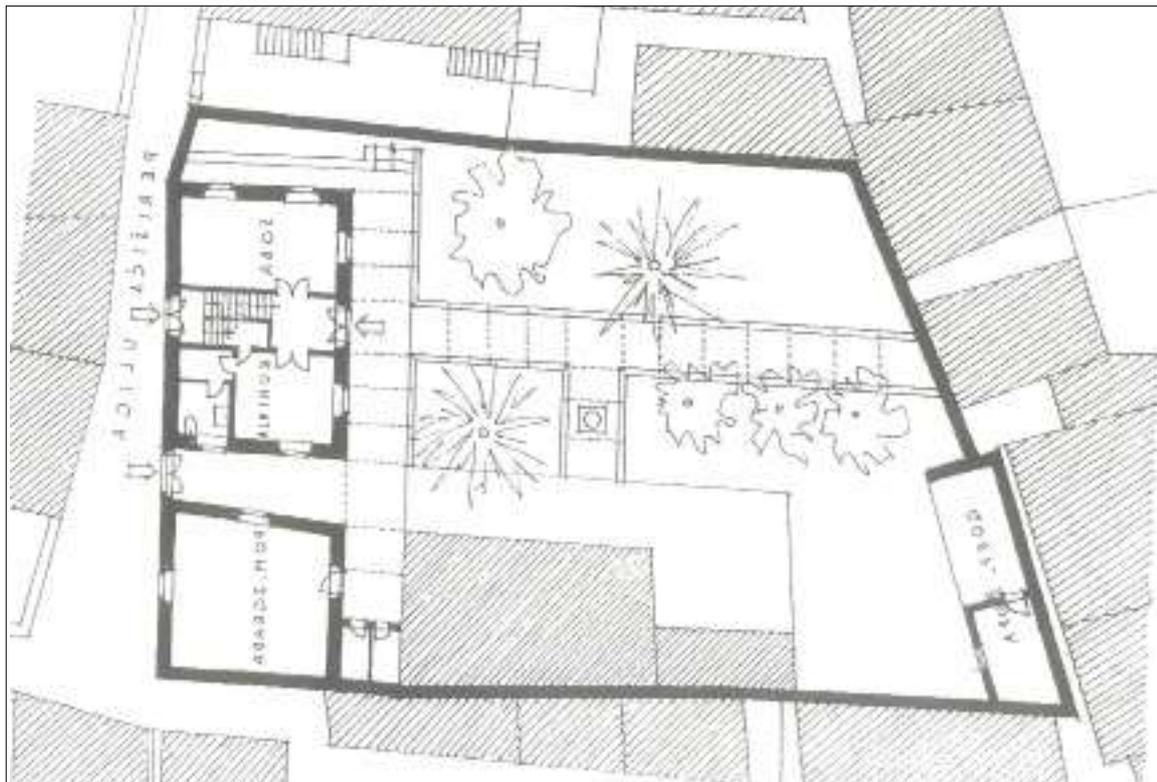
Split, Varoš, Grundriss eines traditionellen zweistöckigen Stadthauses mit einer zentral positionierten Leuchte, einem großen Garten und eine Werkgebäude, M1:200
